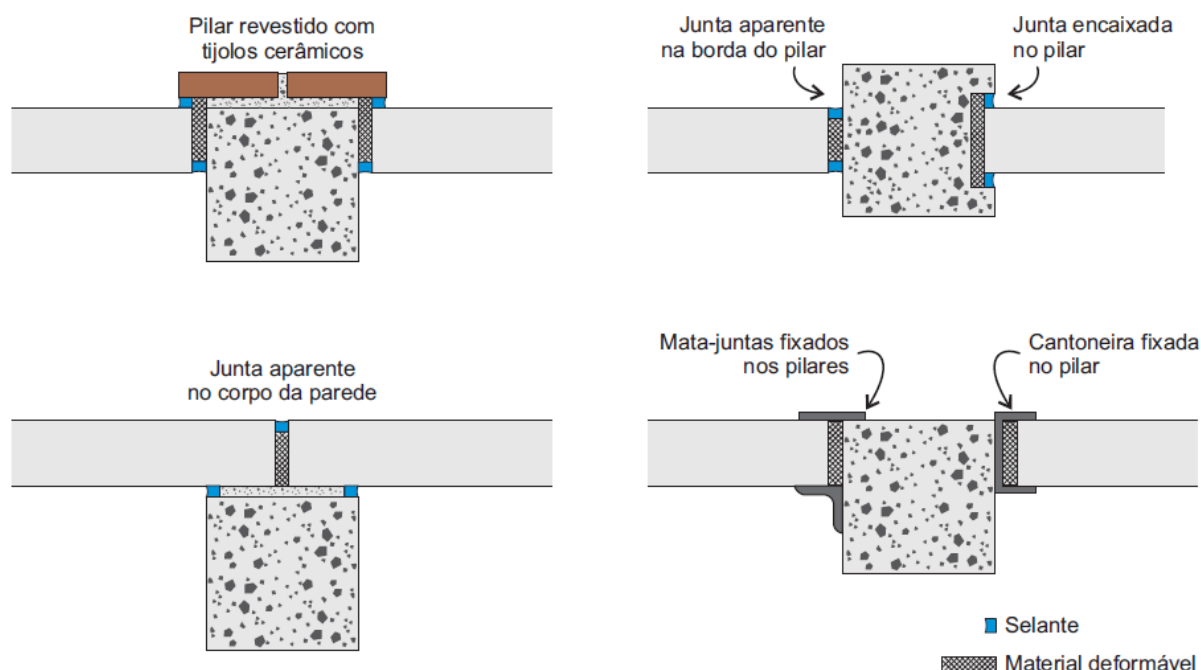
Ligações entre alvenarias e pilares, recomendadas para estruturas flexíveis. Fonte: Thomaz et al. (2009).
